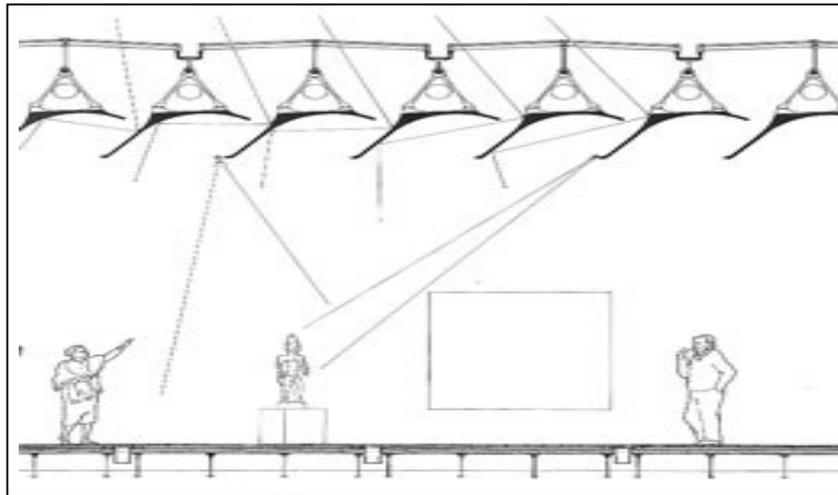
Proyecciones de la iluminación cenital en el museo Menil Collection de Renzo Piano.
